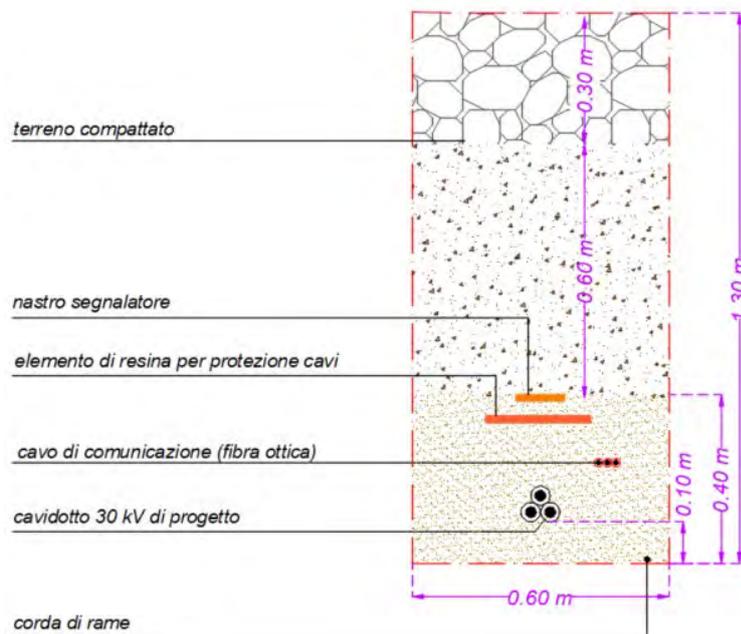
Sezione cavidotto singola terna su misto stabilizzato
